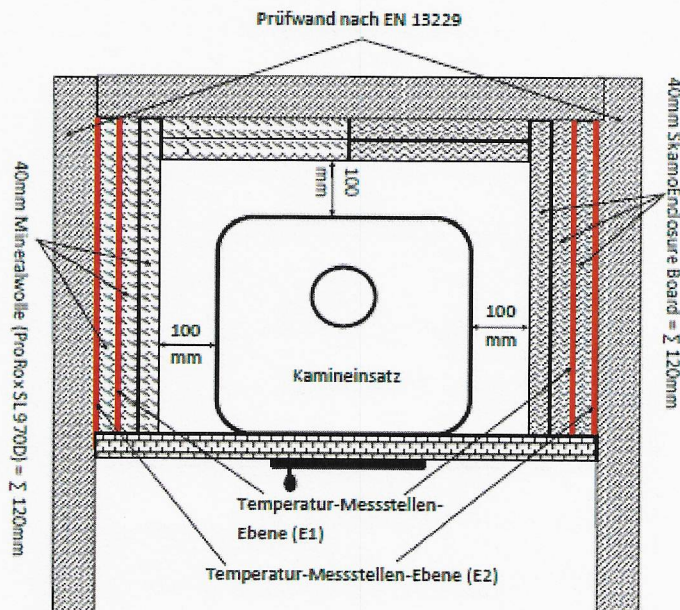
Draufsicht-Schnitt: Prüfaufbau Versuchstag 2: 120 mm SkamoEnclosure Board und 120 mm Mineralwolle
